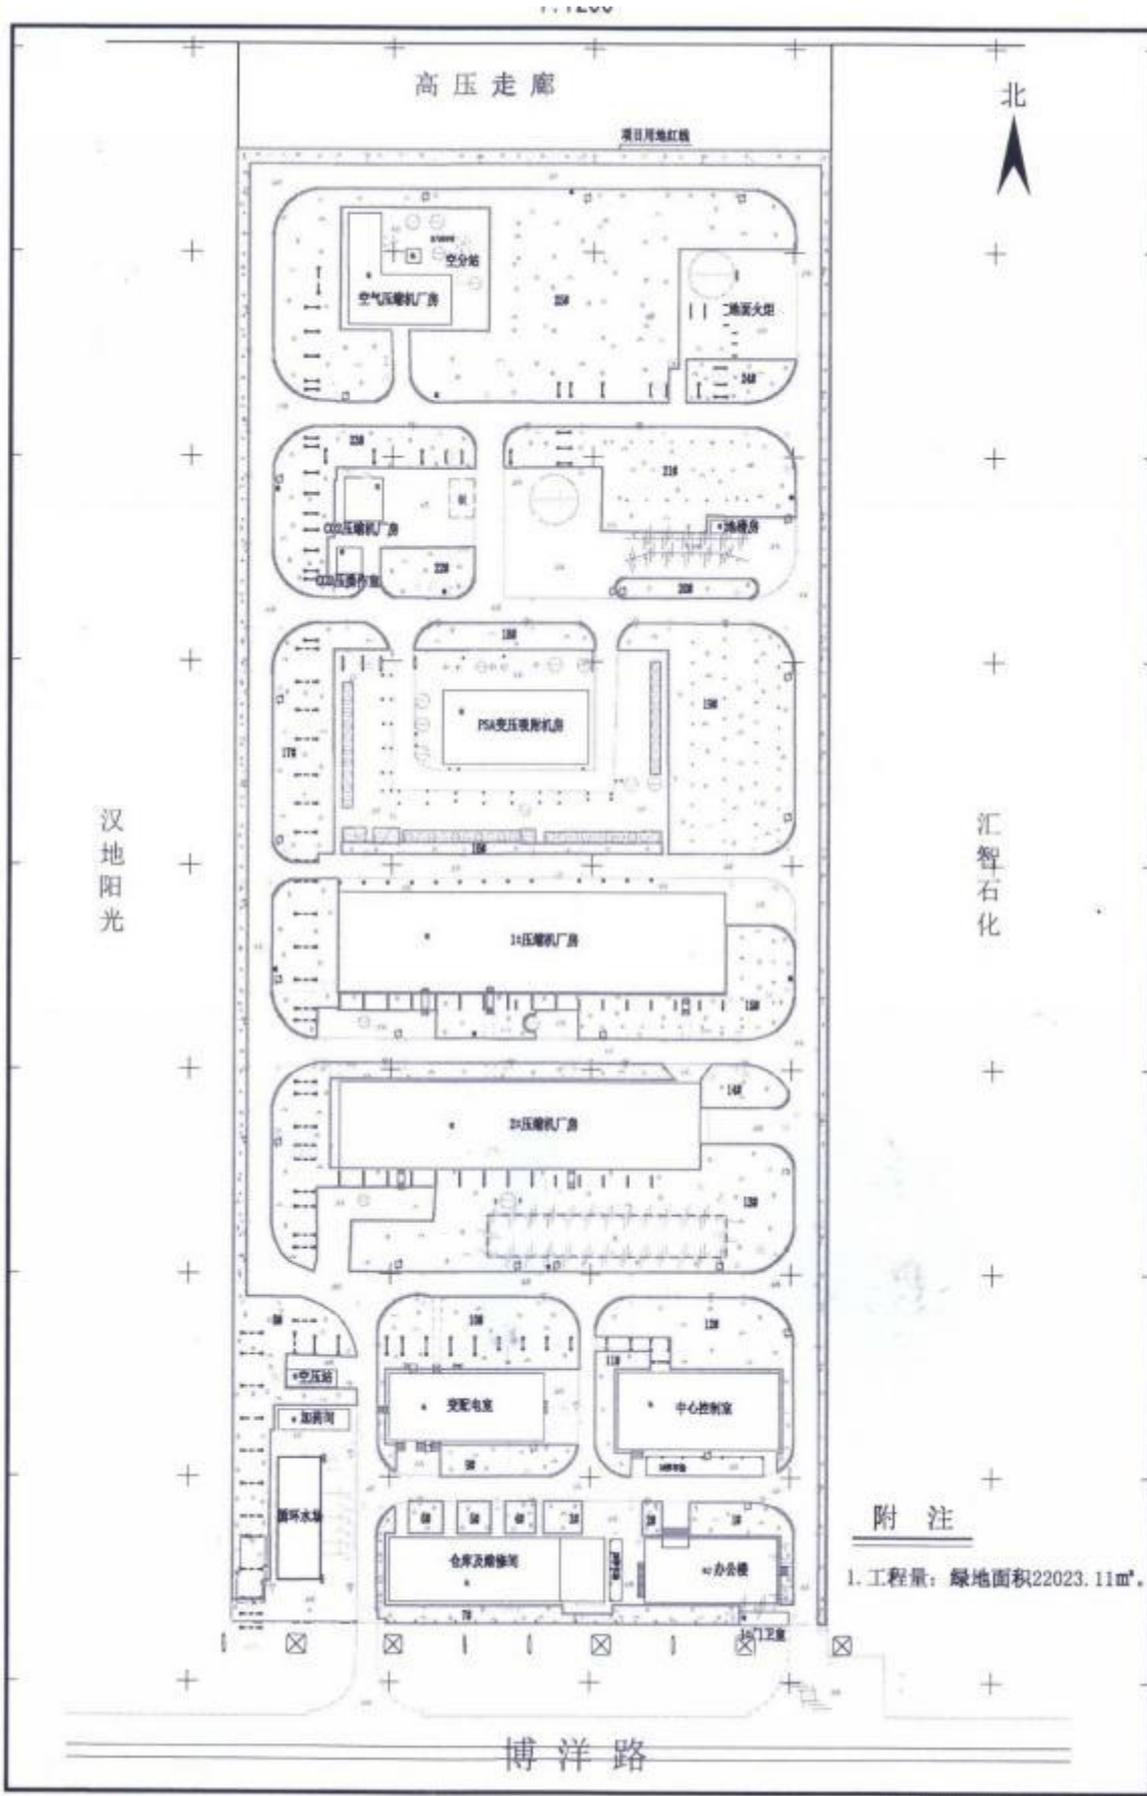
海南凯美特气体有限公司厂区平面布置示意图
